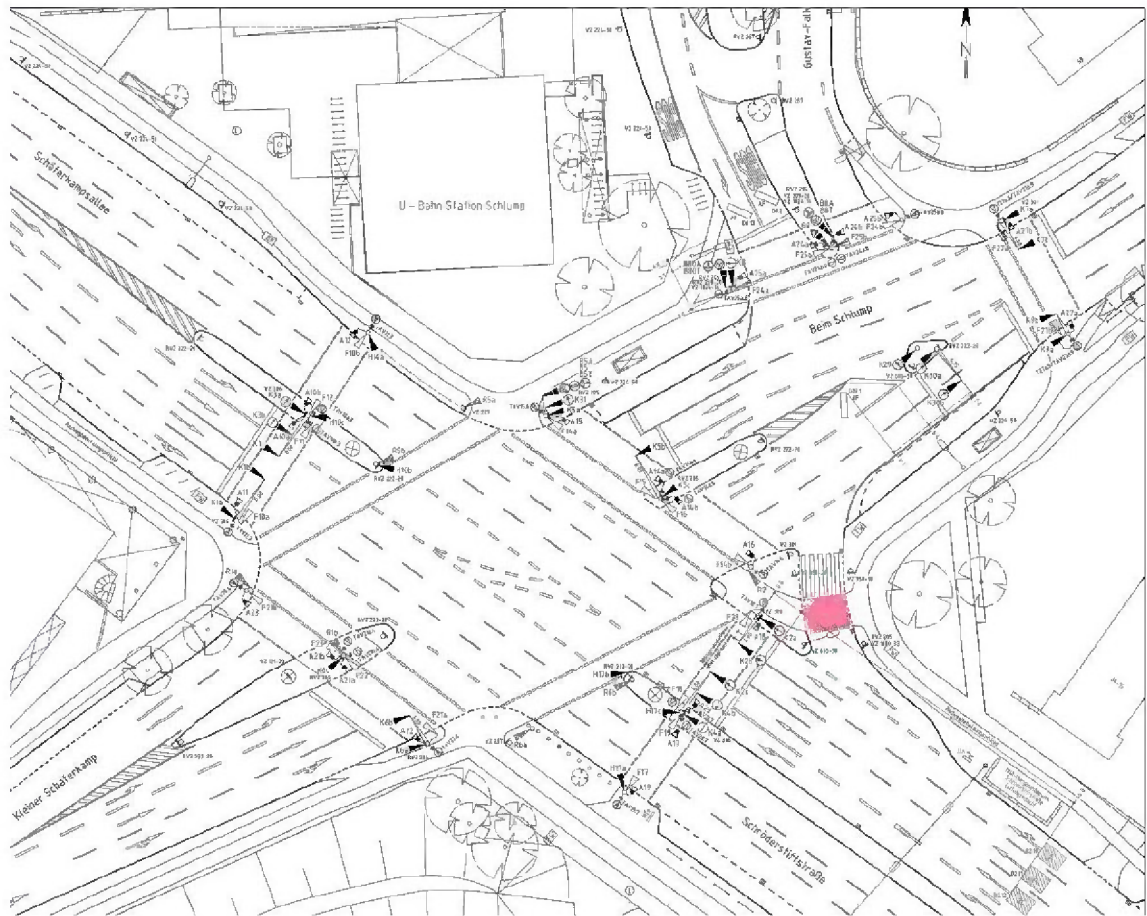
Signallageplan Schäferkampsallee/Kleiner Schäferkamp – Bestand (16/813-04-03/03)
